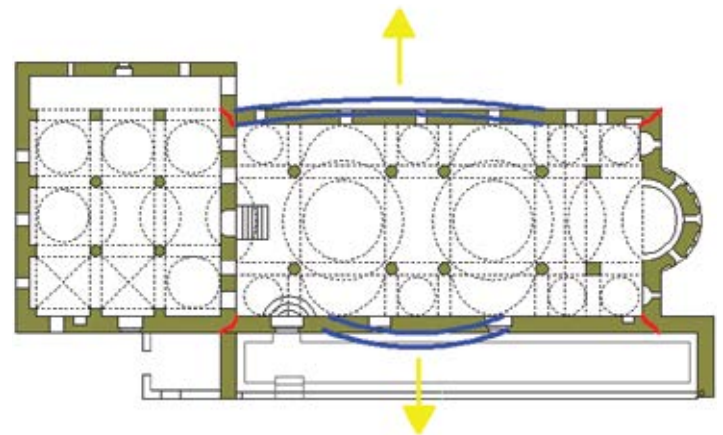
Deformimi i muraturës në plan (prezantimi i Grupit 4)
